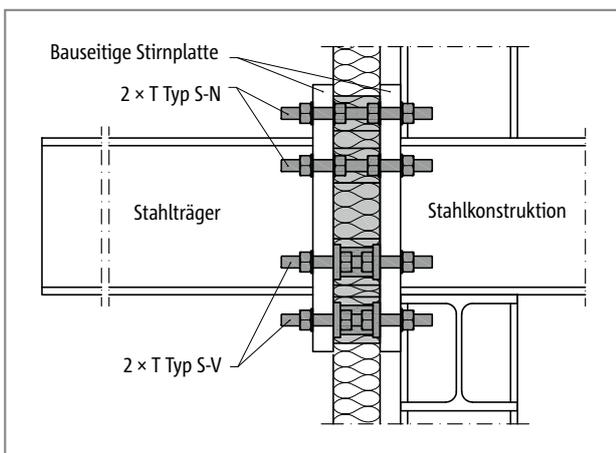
Schöck Isokorb® T Typ S-N und T Typ S-V: Stahlkonstruktion frei auskragend
